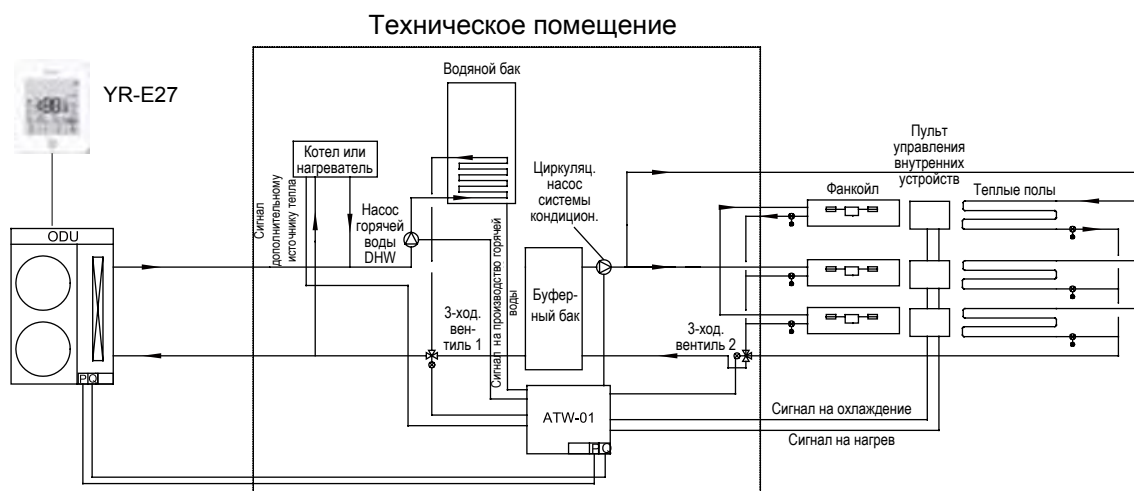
Производство горячей воды для бытовых нужд (DHW) под управлением контроллера пользователя
